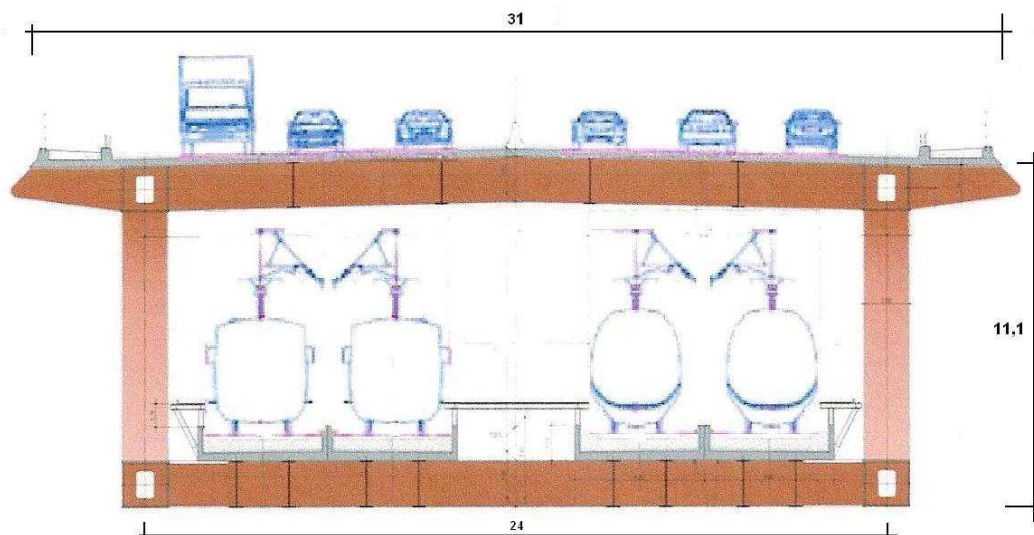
Secção Transversal da ponte Chelas-Barreiro (RAVE)
